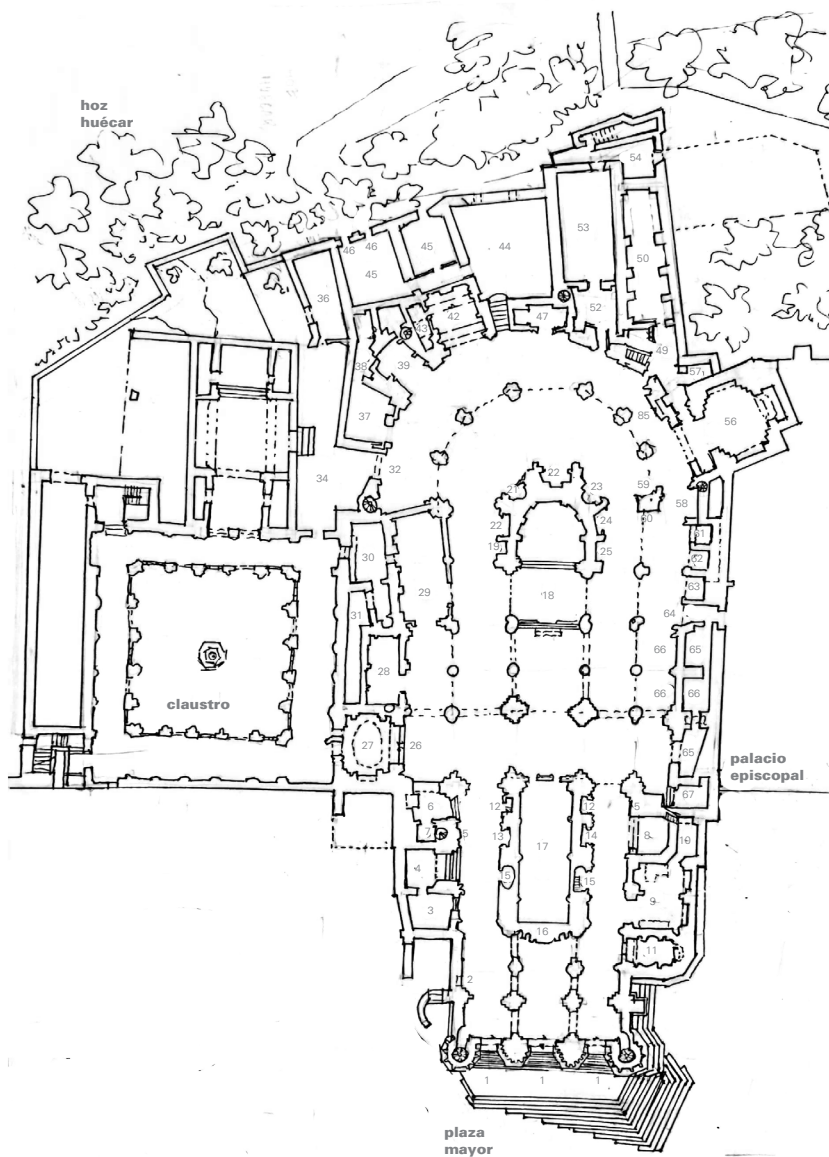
Planta general actual sobre plano de Gema Palomo. Elaboración propia
